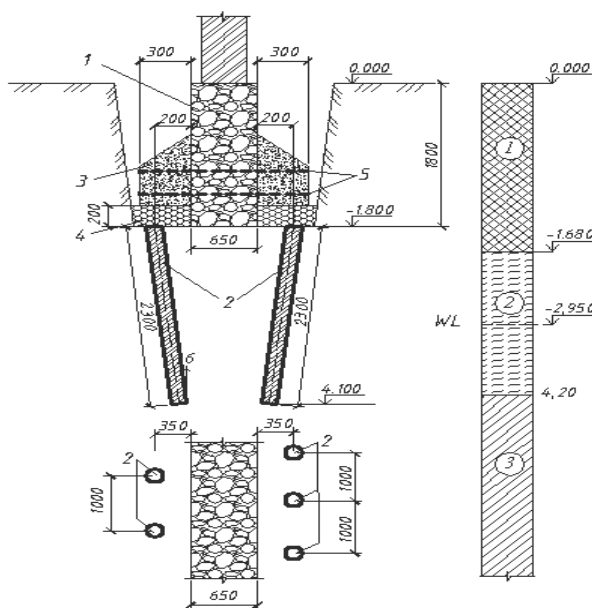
Схема підсилення фундаменту: 1 – існуючий фундамент; 2 – елементи армування; 3 – елементи розширення фундаменту; 4 – розподільна подушка; 5 – металеві тяжі
